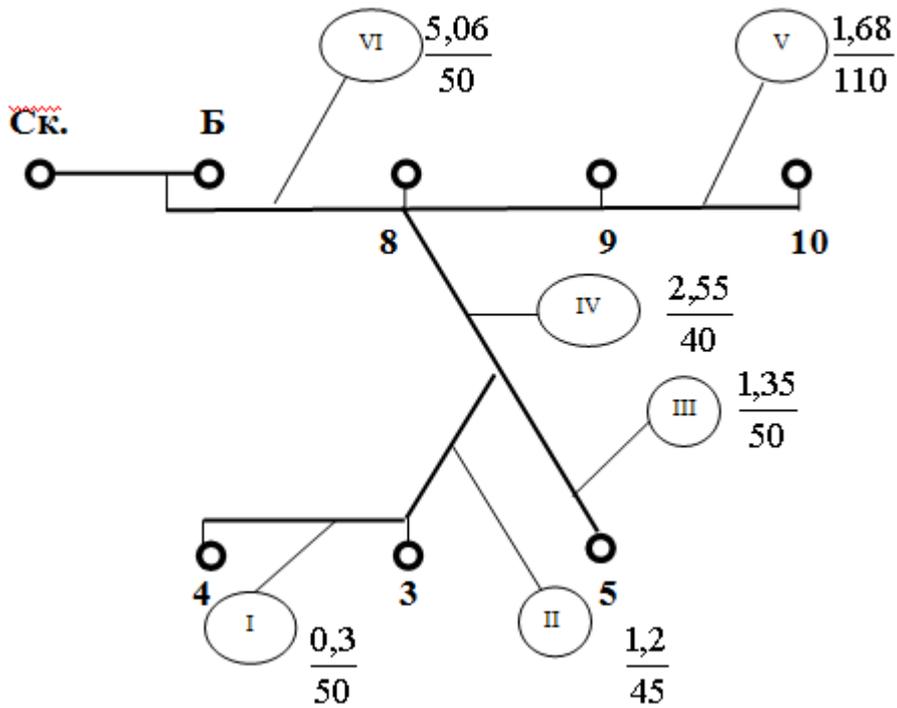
Расчетная схема водопроводной сети с участком с путевым расходом воды на участке VI.
